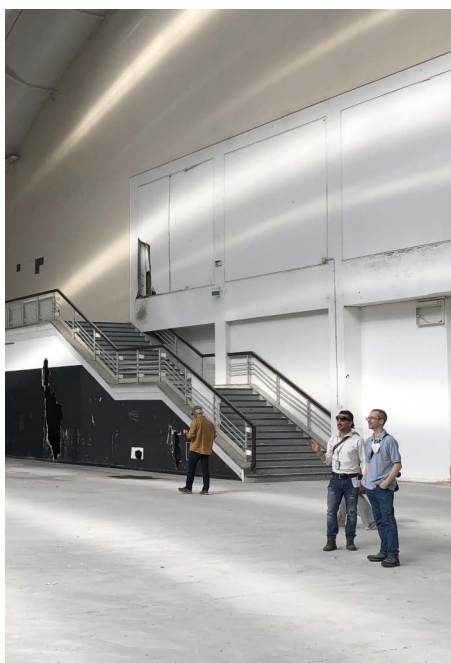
Prospetto scalinate verso Padiglione 2B P1
